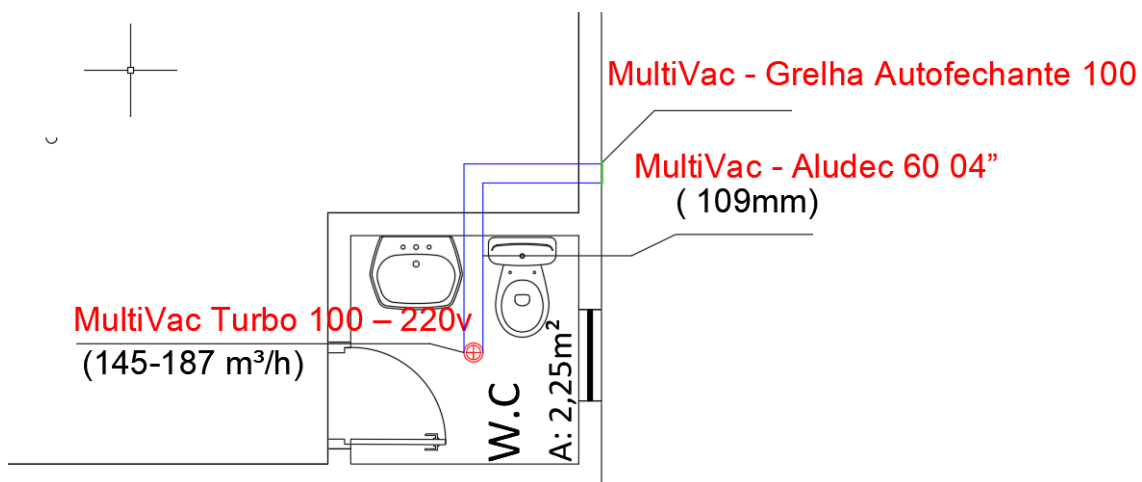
Planta baixa do banheiro – Sistema de exaustão
